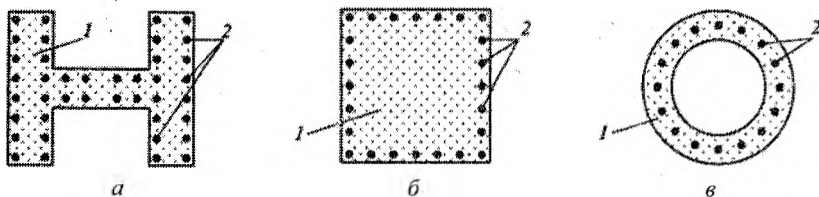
Поперечний переріз стійок залізобетонних опор:
